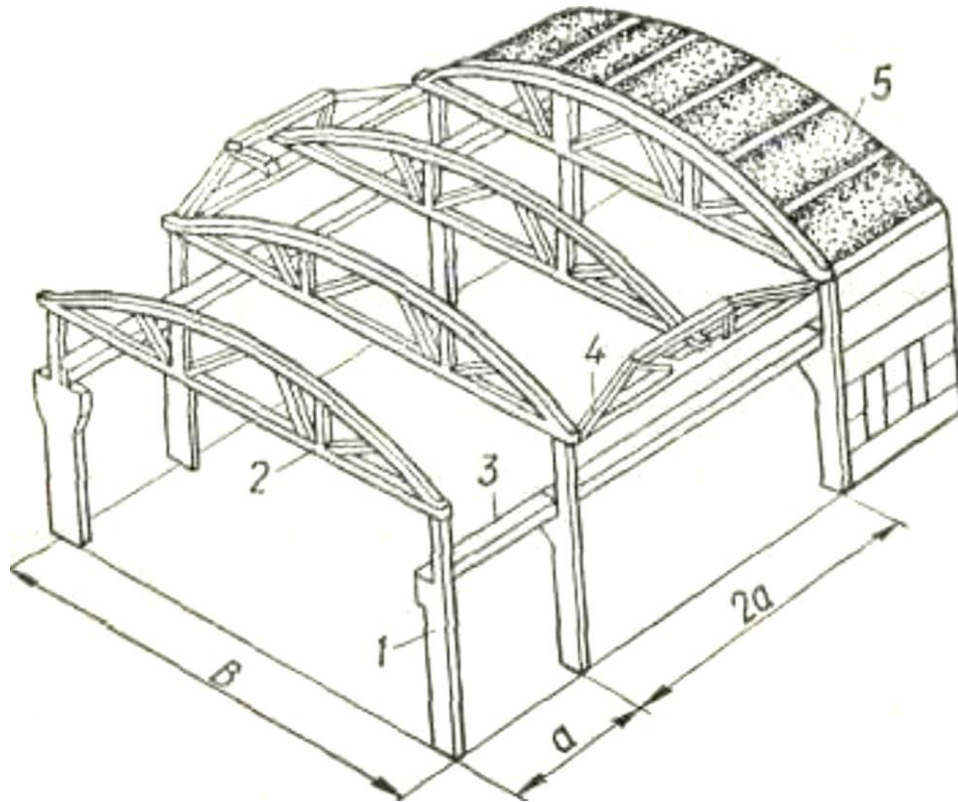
Каркас одноповерхового будинку (залізобетонний):
